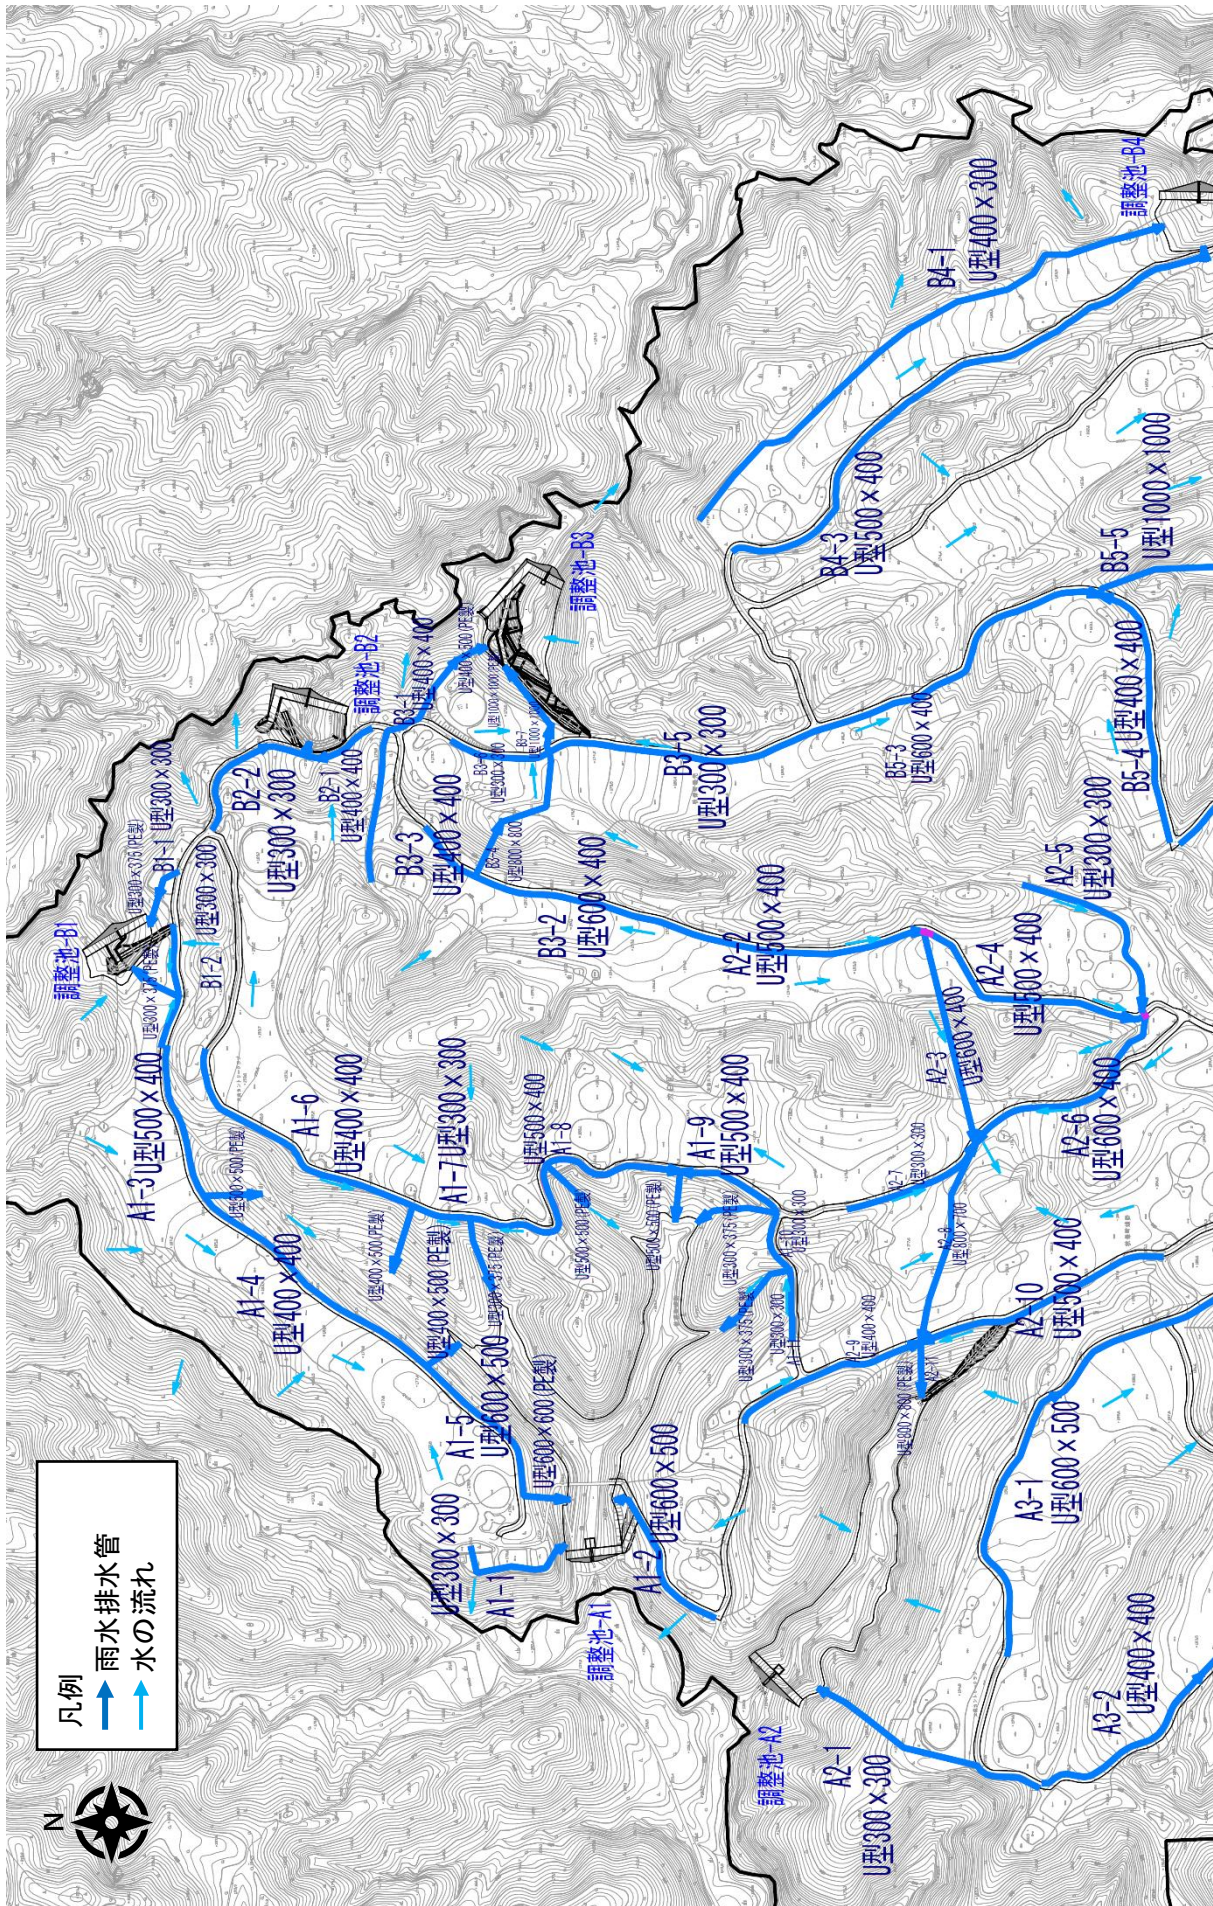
雨水排水施設平面図 (対象事業実施区域 北)
